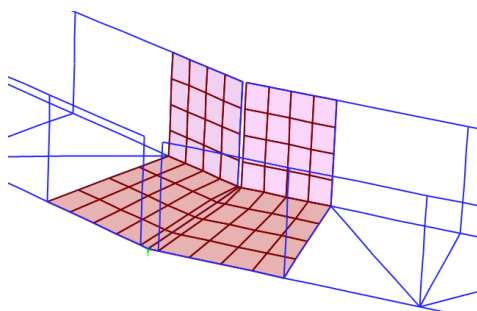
Discretização da malha na laje maciça e nas chapas metálicas, junto ao pilar P1
